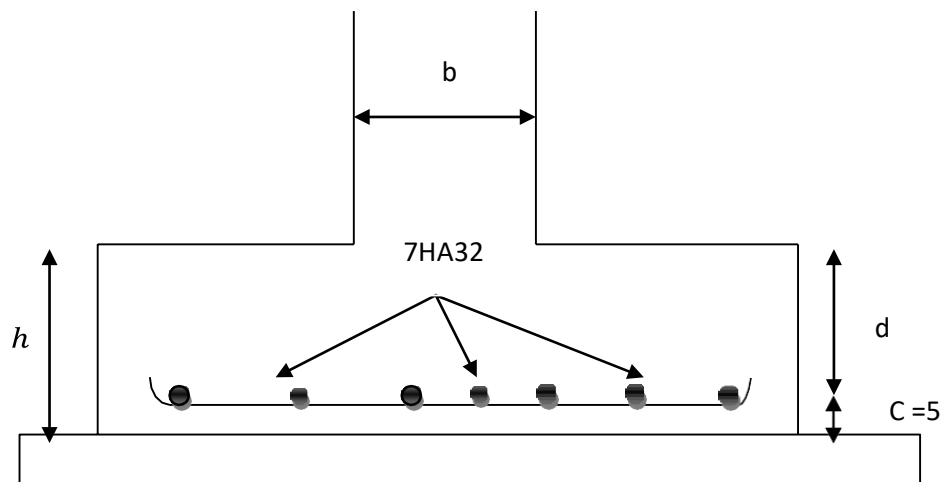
Dimension des semelles et disposition constructive des armatures.
